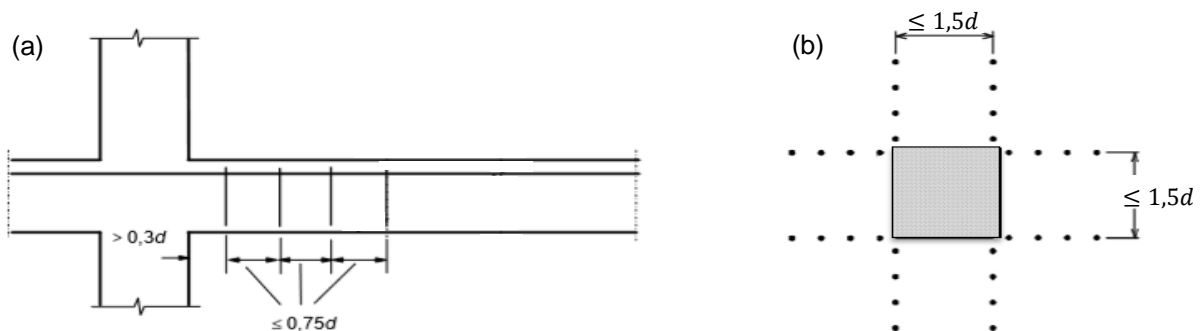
Disposição construtiva, presente no EC2-1, para as armaduras transversais: (a) Em alçado; (b) Em planta (adaptado de [4] e [26])
